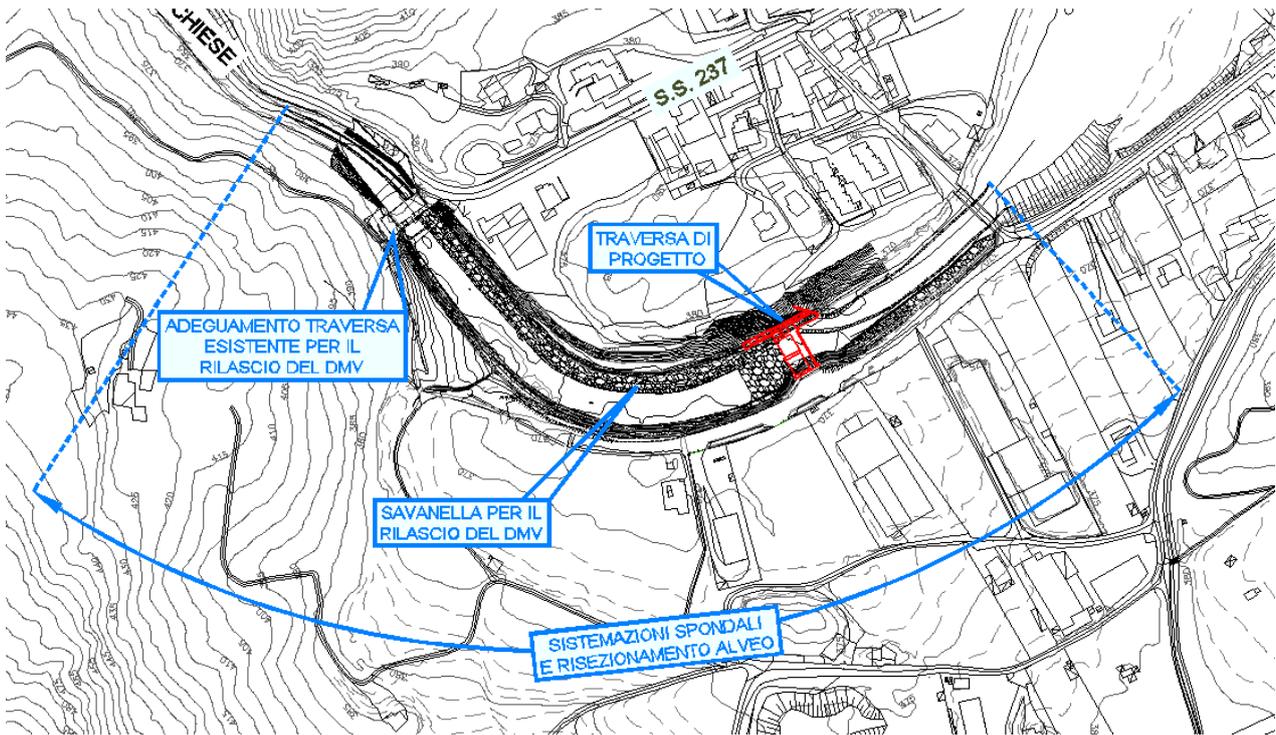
Localizzazione della traversa esistente e di progetto, lungo il tratto del Chiese interessato dai lavori.
